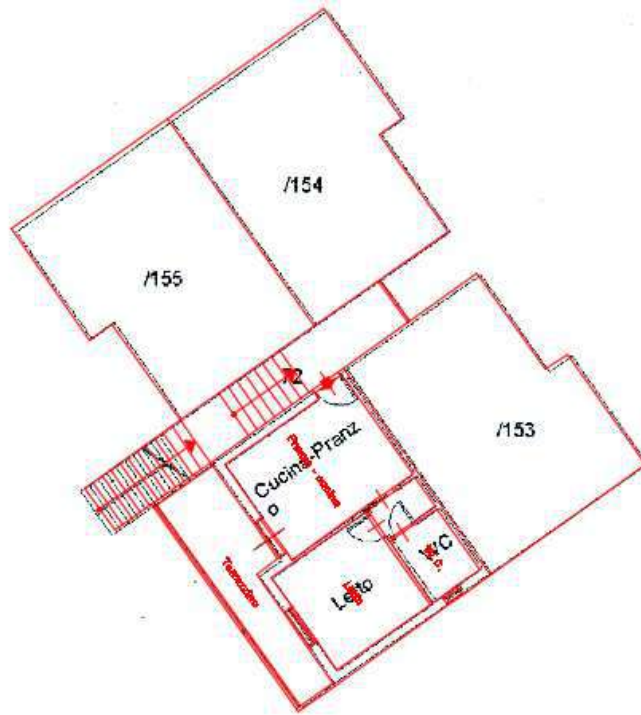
Sovrapposizione della planimetria di rilievo sulla planimetria catastale
